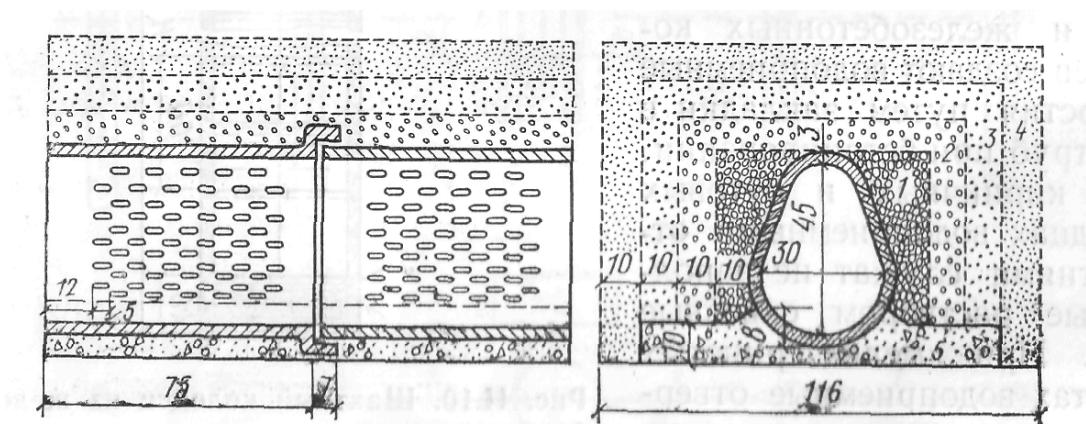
Горизонтальный водозабор из железобетонных труб овoidalного сечения
